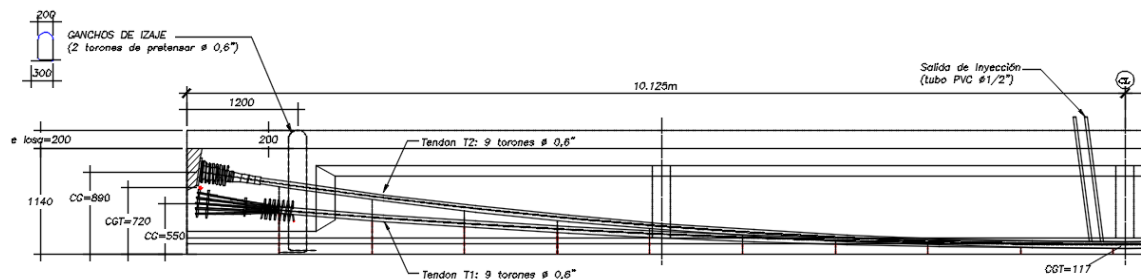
Perfil de los tendones postensado de las vigas longitudinales
